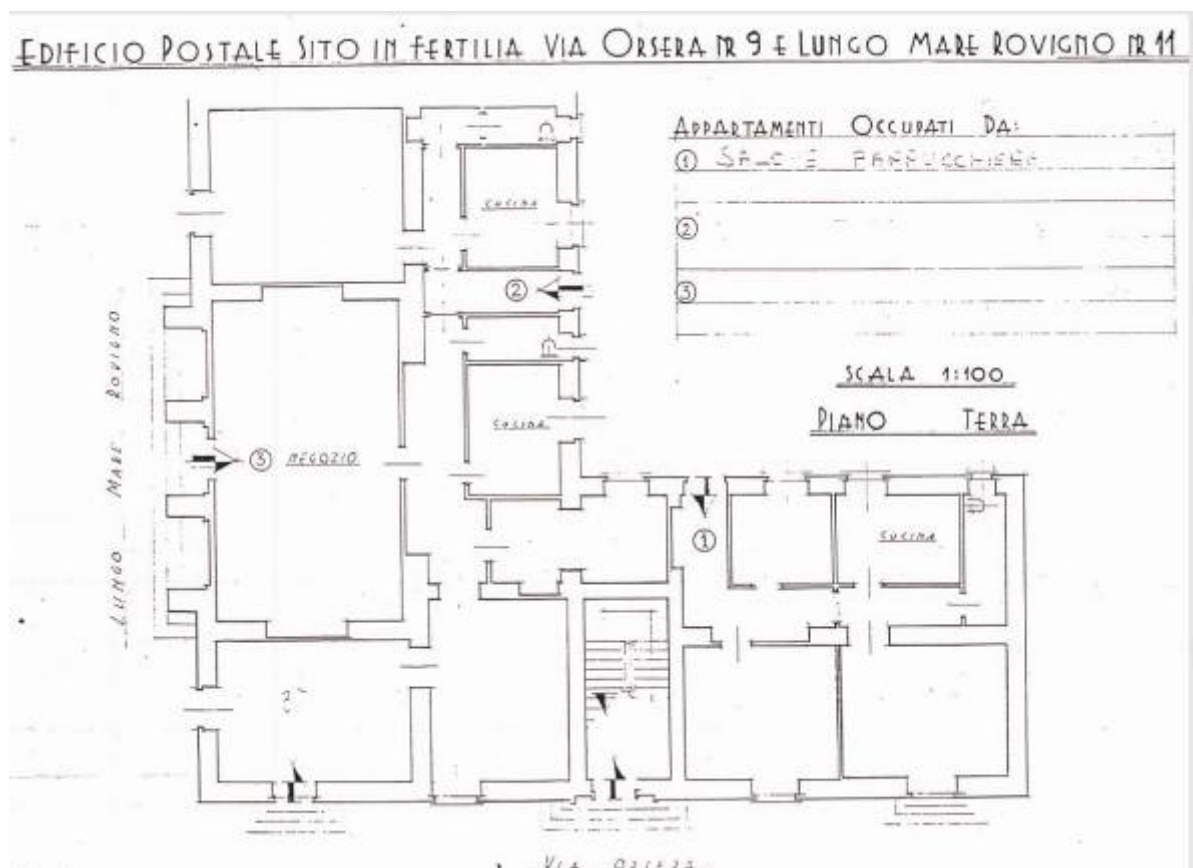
Pianta del Piano Terra dell'Ufficio Postelegrafico.
